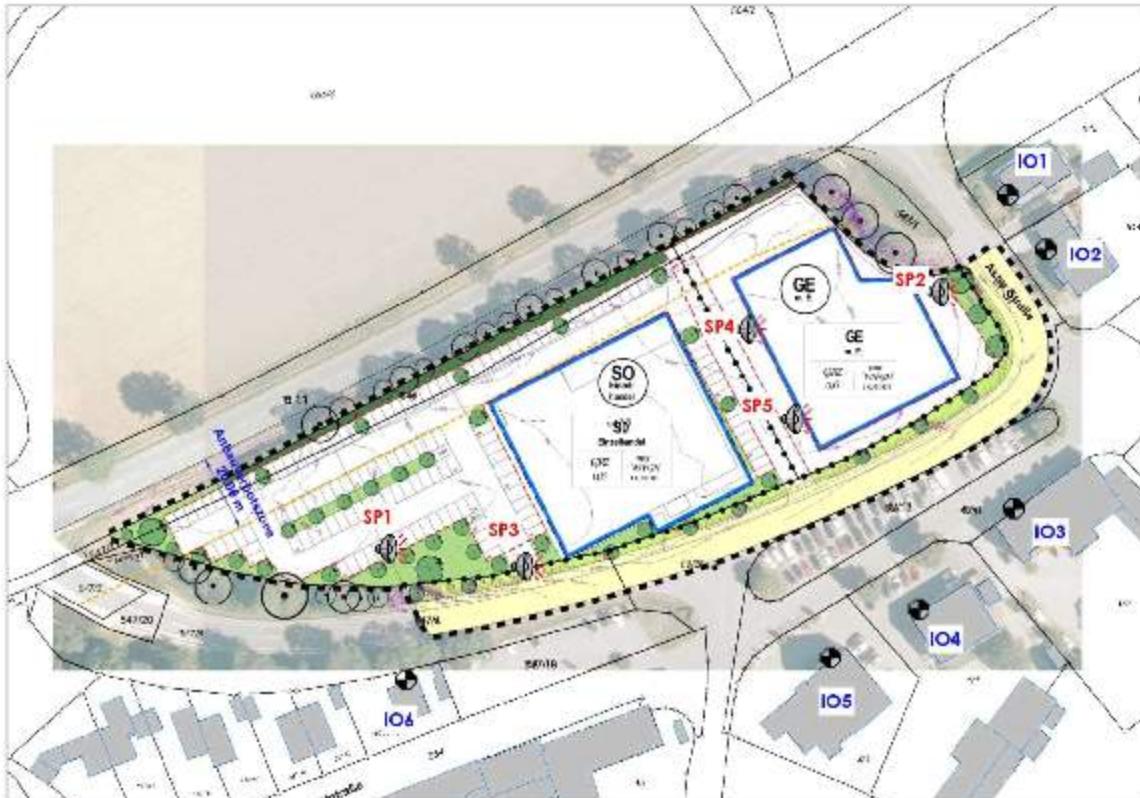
Lageplan mit Darstellung der Punktschallquellen (SP1-5)
